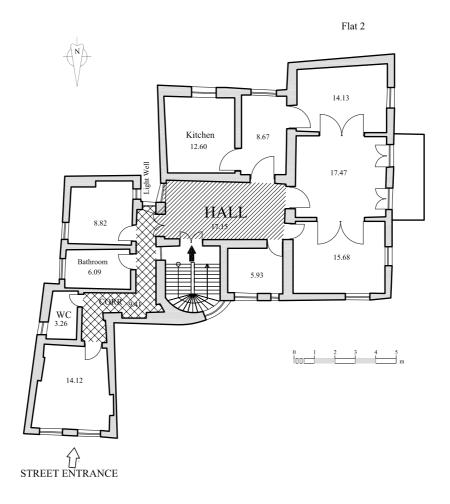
a. Jones Apartmanı (Apartment 2), plan
